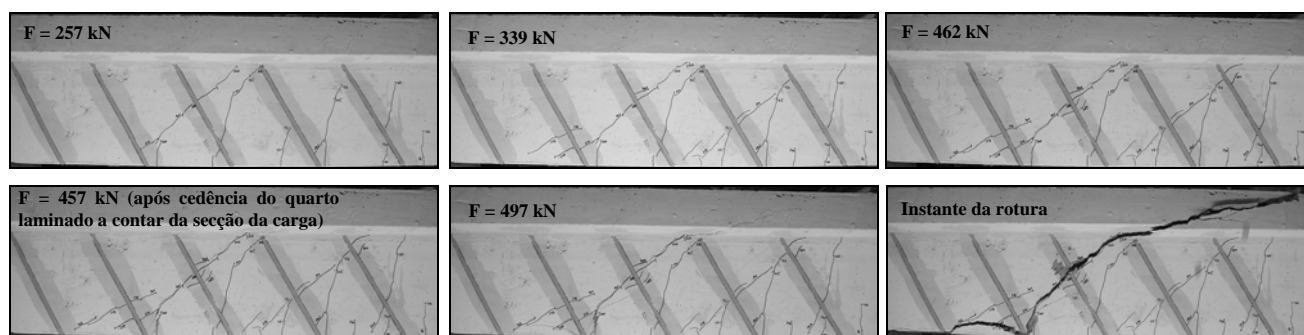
Fases do ensaio da viga 3S-5LI60-D (carga máxima de 497.9 kN).
